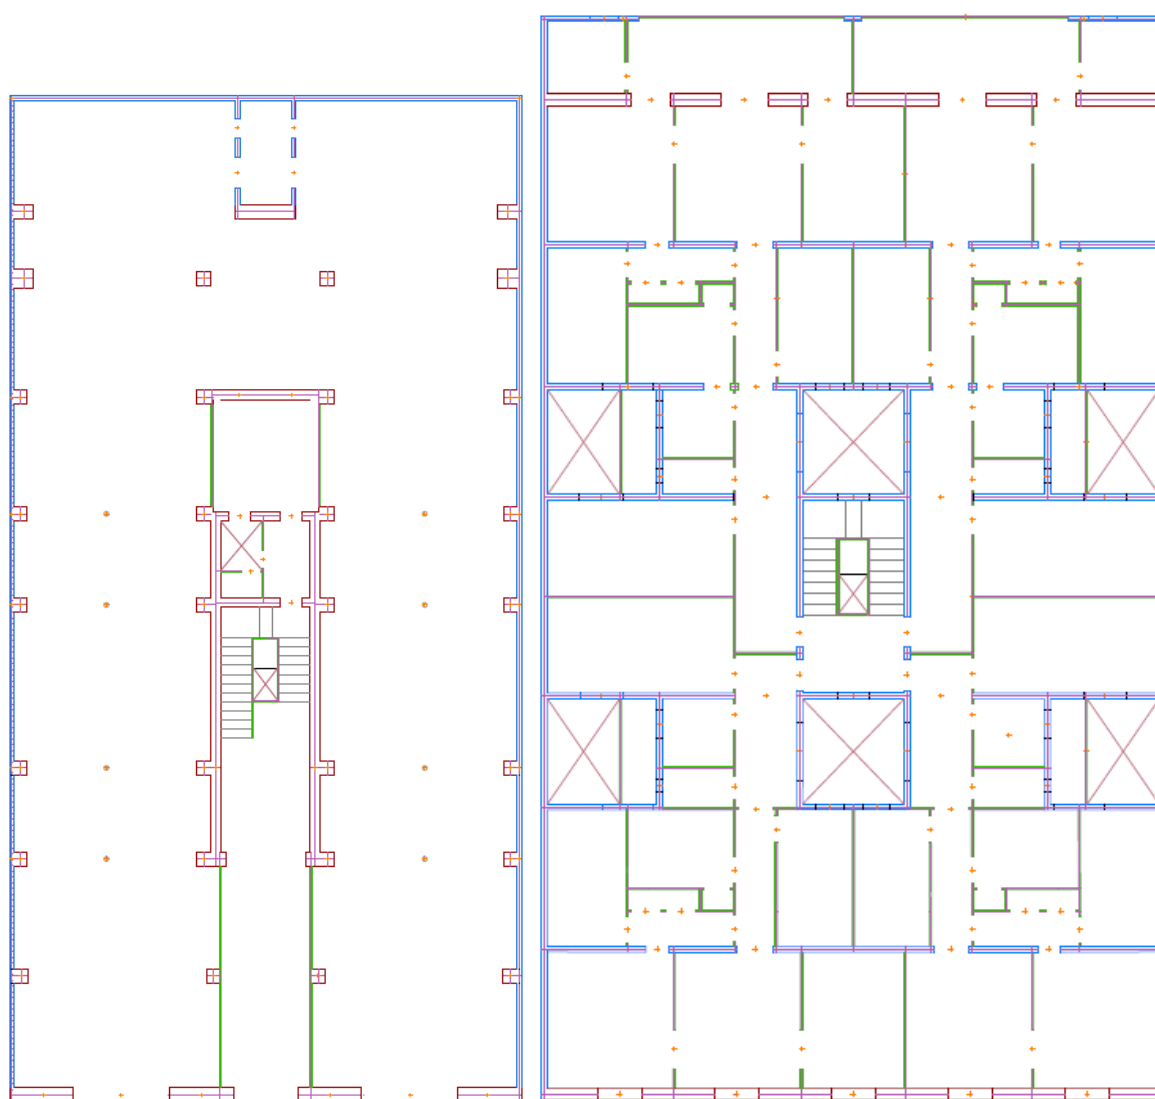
Models CAD de l'edifici individual. S'observa la planta tipus a l'esquerra i la planta baixa a la dreta.
